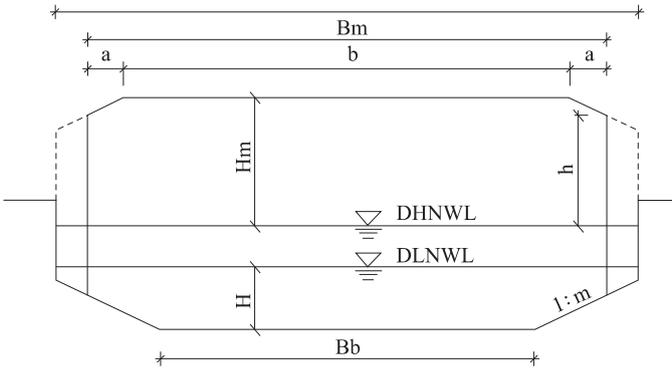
限制性航道通航净空和航道断面示意图
